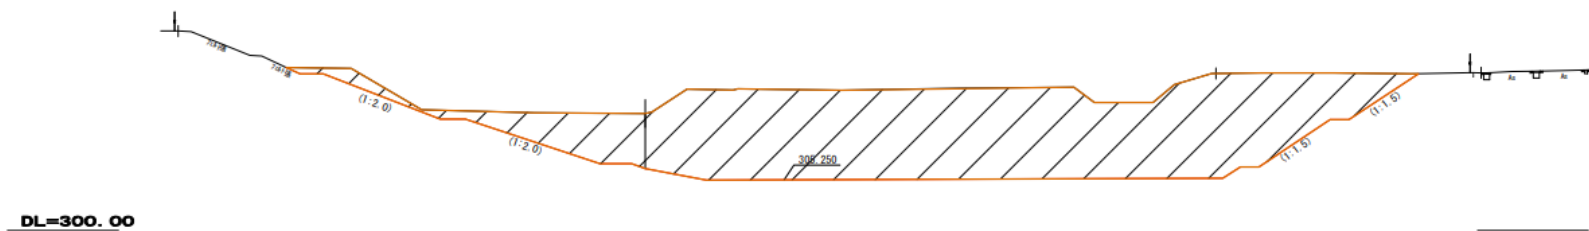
(1) 掘削平面図及び掘削横断面
